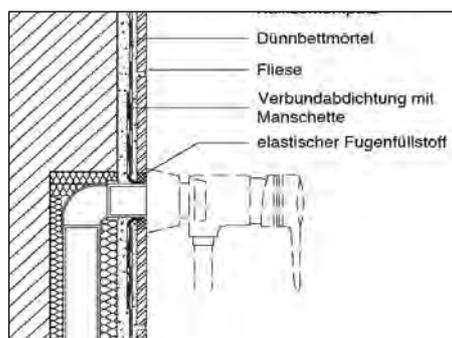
Installationsdurchführung gemäß ZDB-Merkblatt [4]
